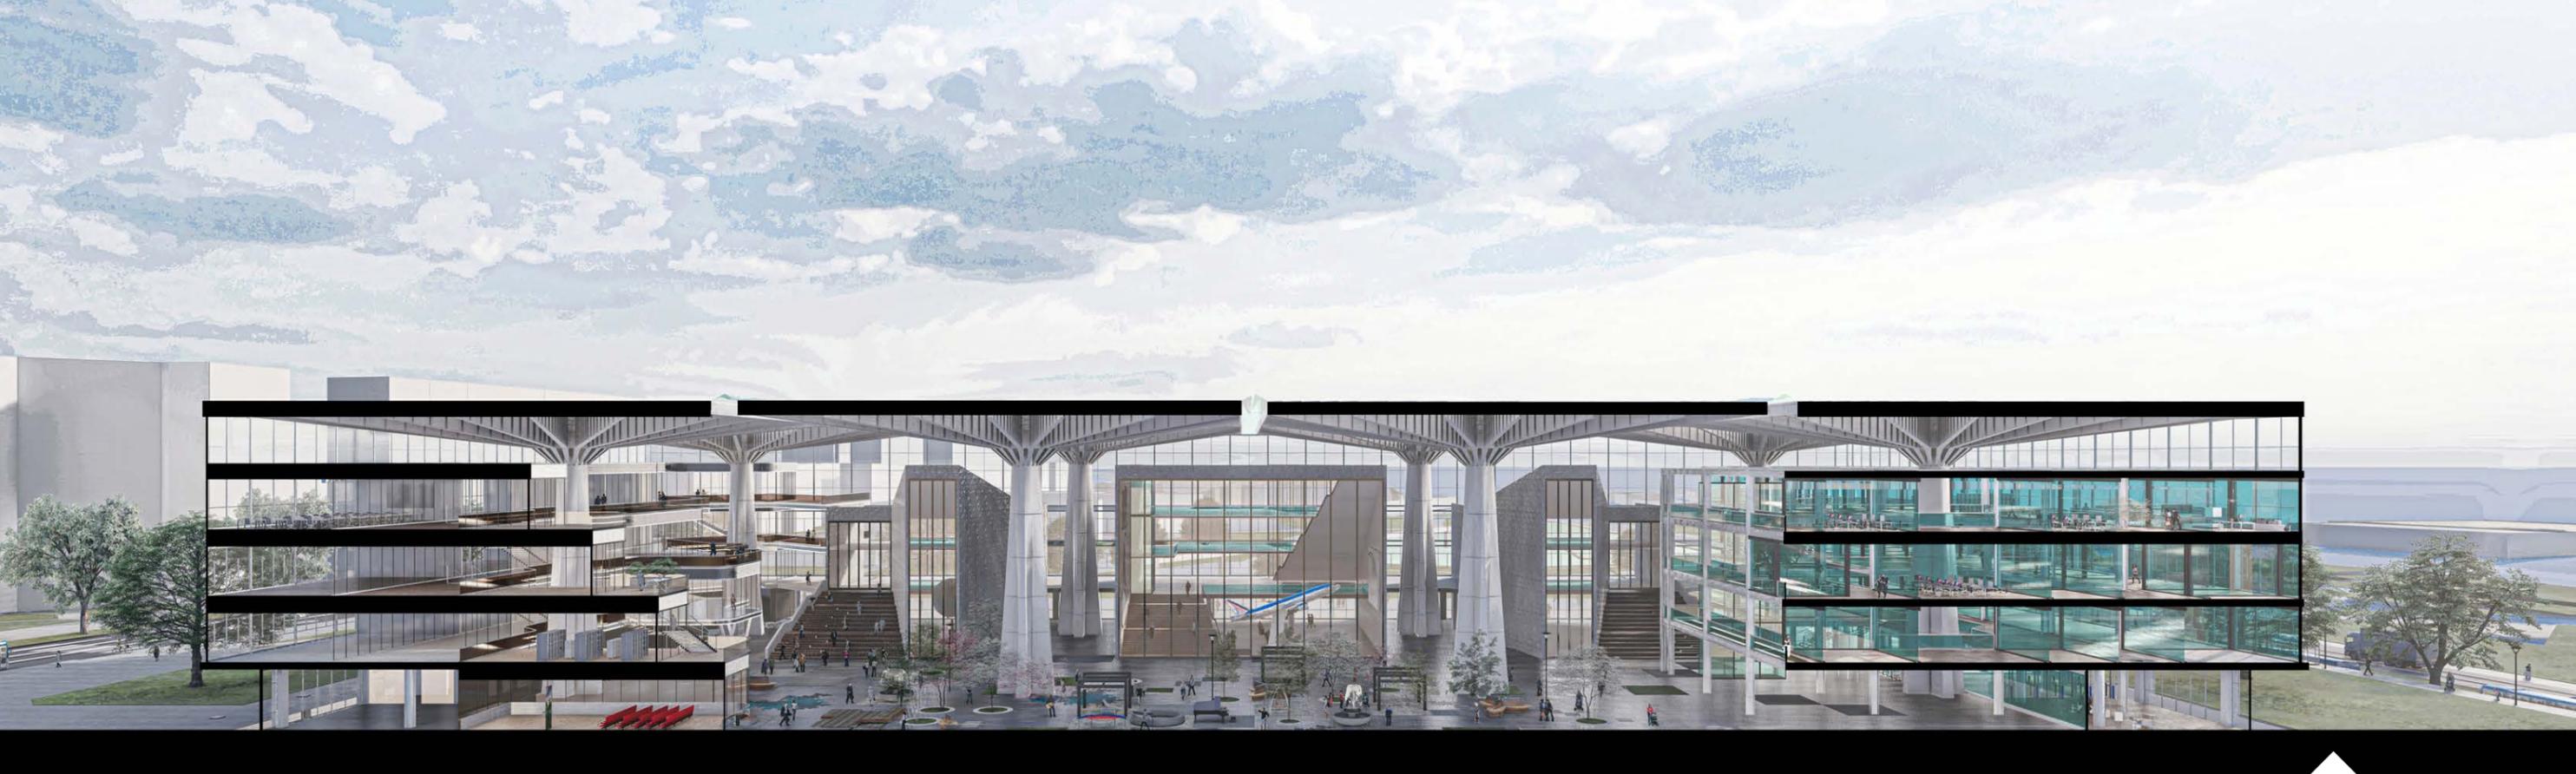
Sezione prospettica raffigurante il lato Co-working-Università, elaborato degli autori.
